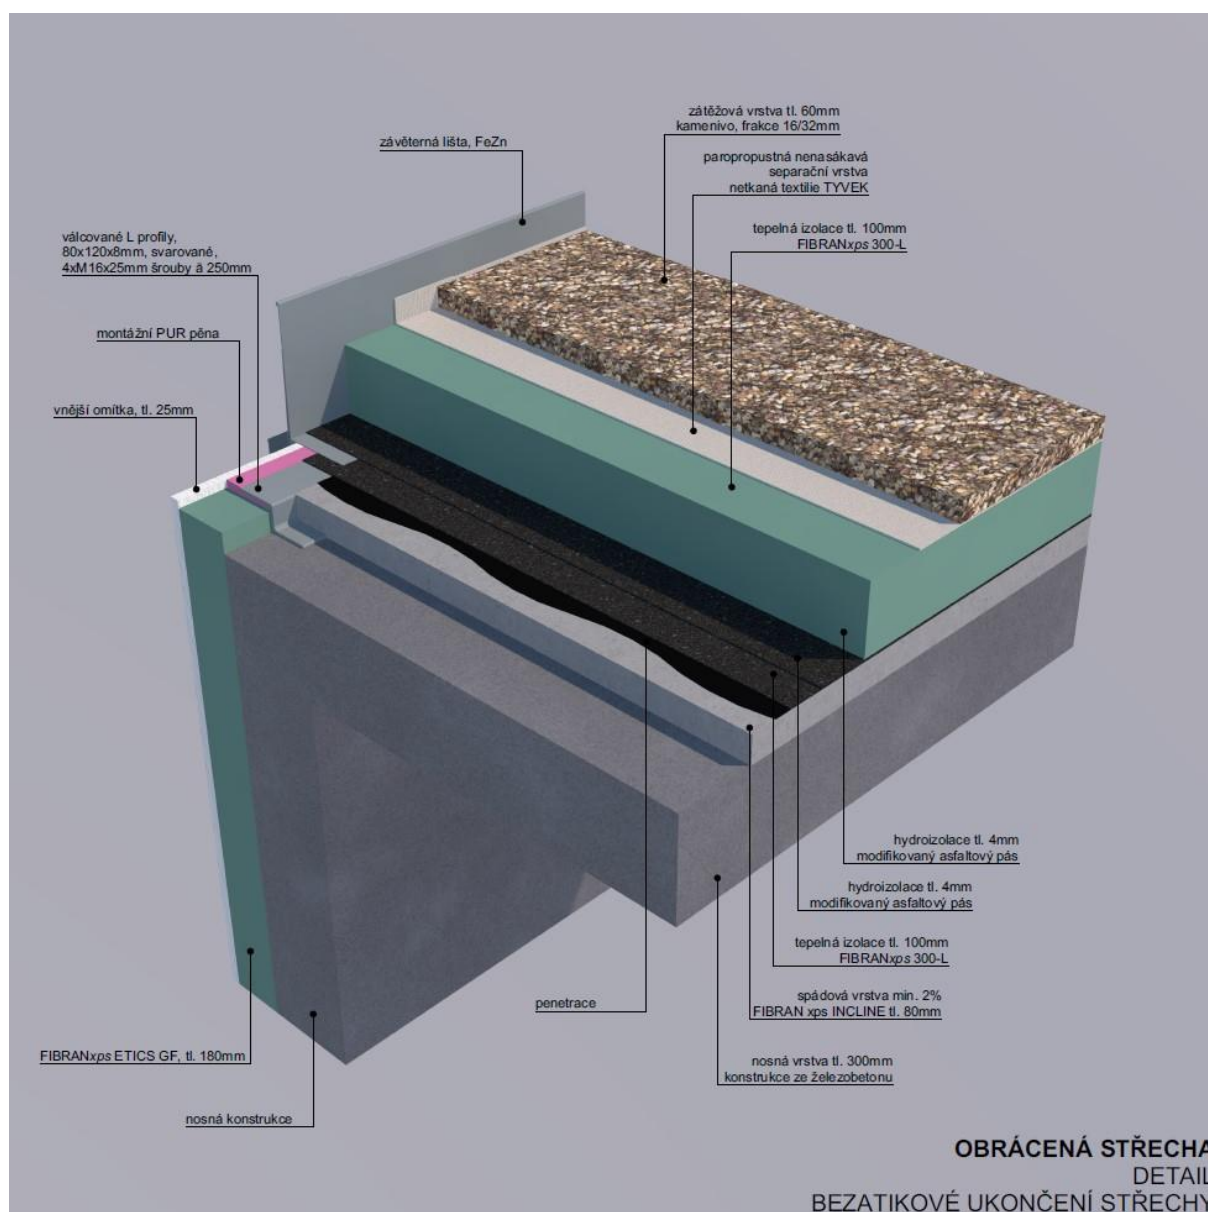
Příklad konstrukčního detailu vytvořeného pro systém BIM – skladba střešního pláště je zde kombinovaná.
